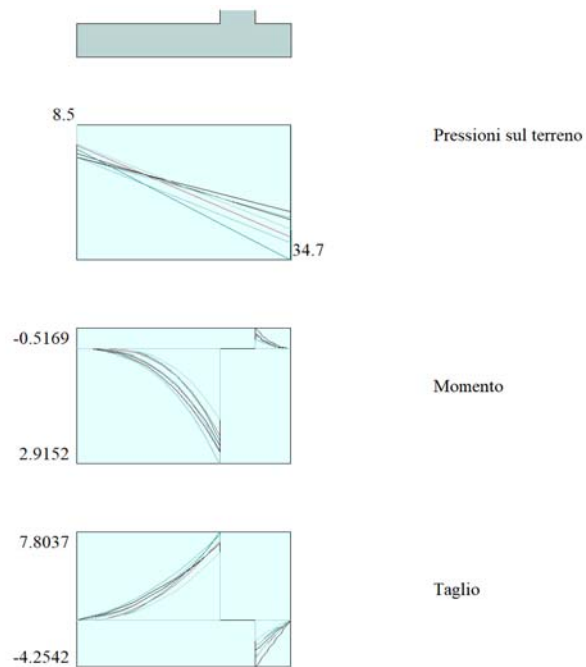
Sollecitazioni massime sulla fondazione (SLU) – condizione non drenata
